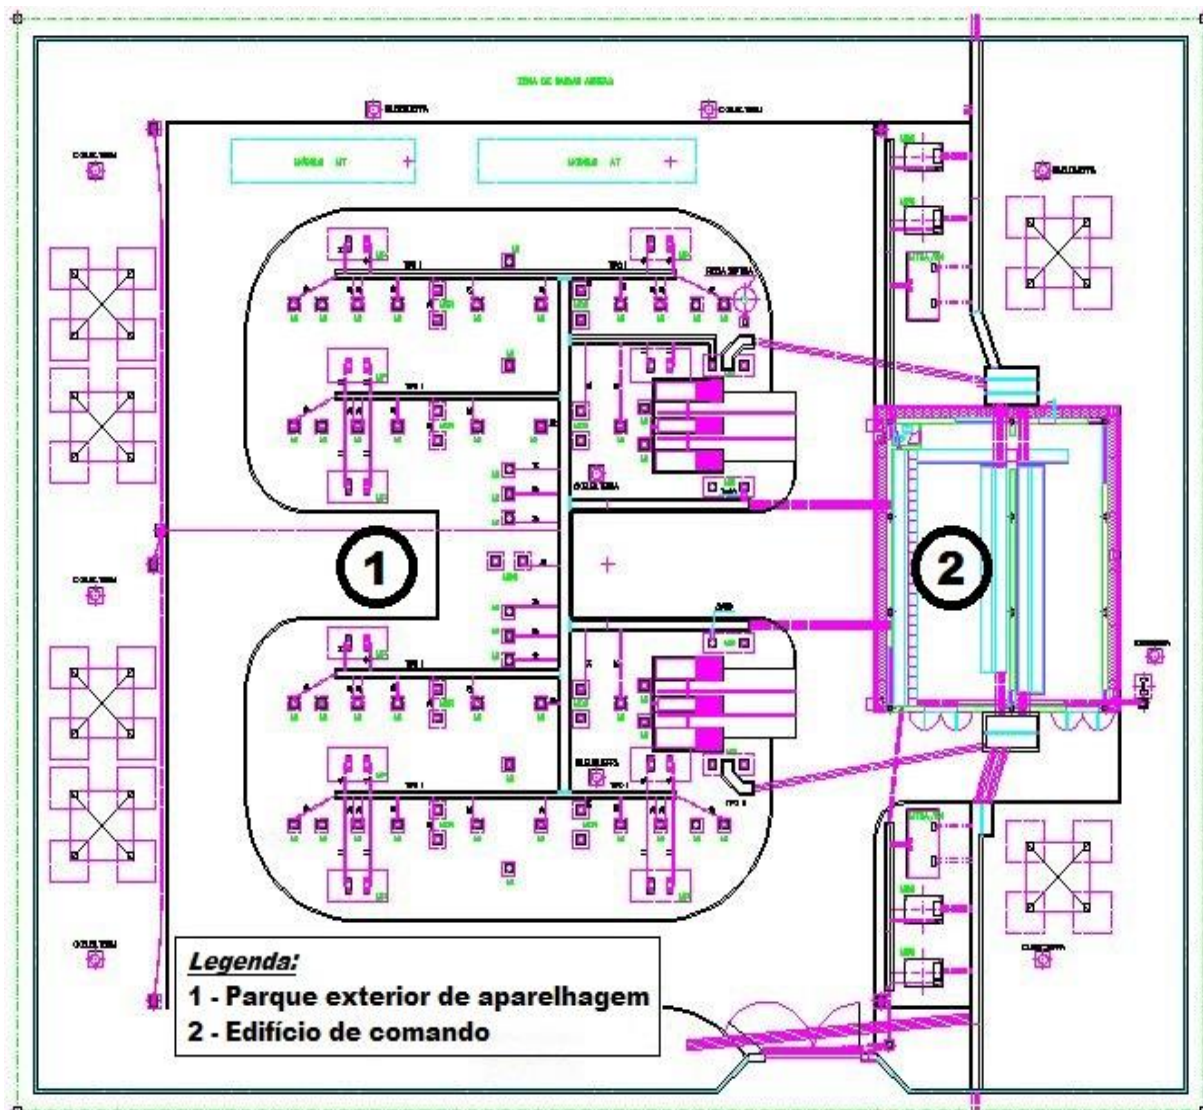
Planta de uma subestação-tipo rural (2ª fase)
